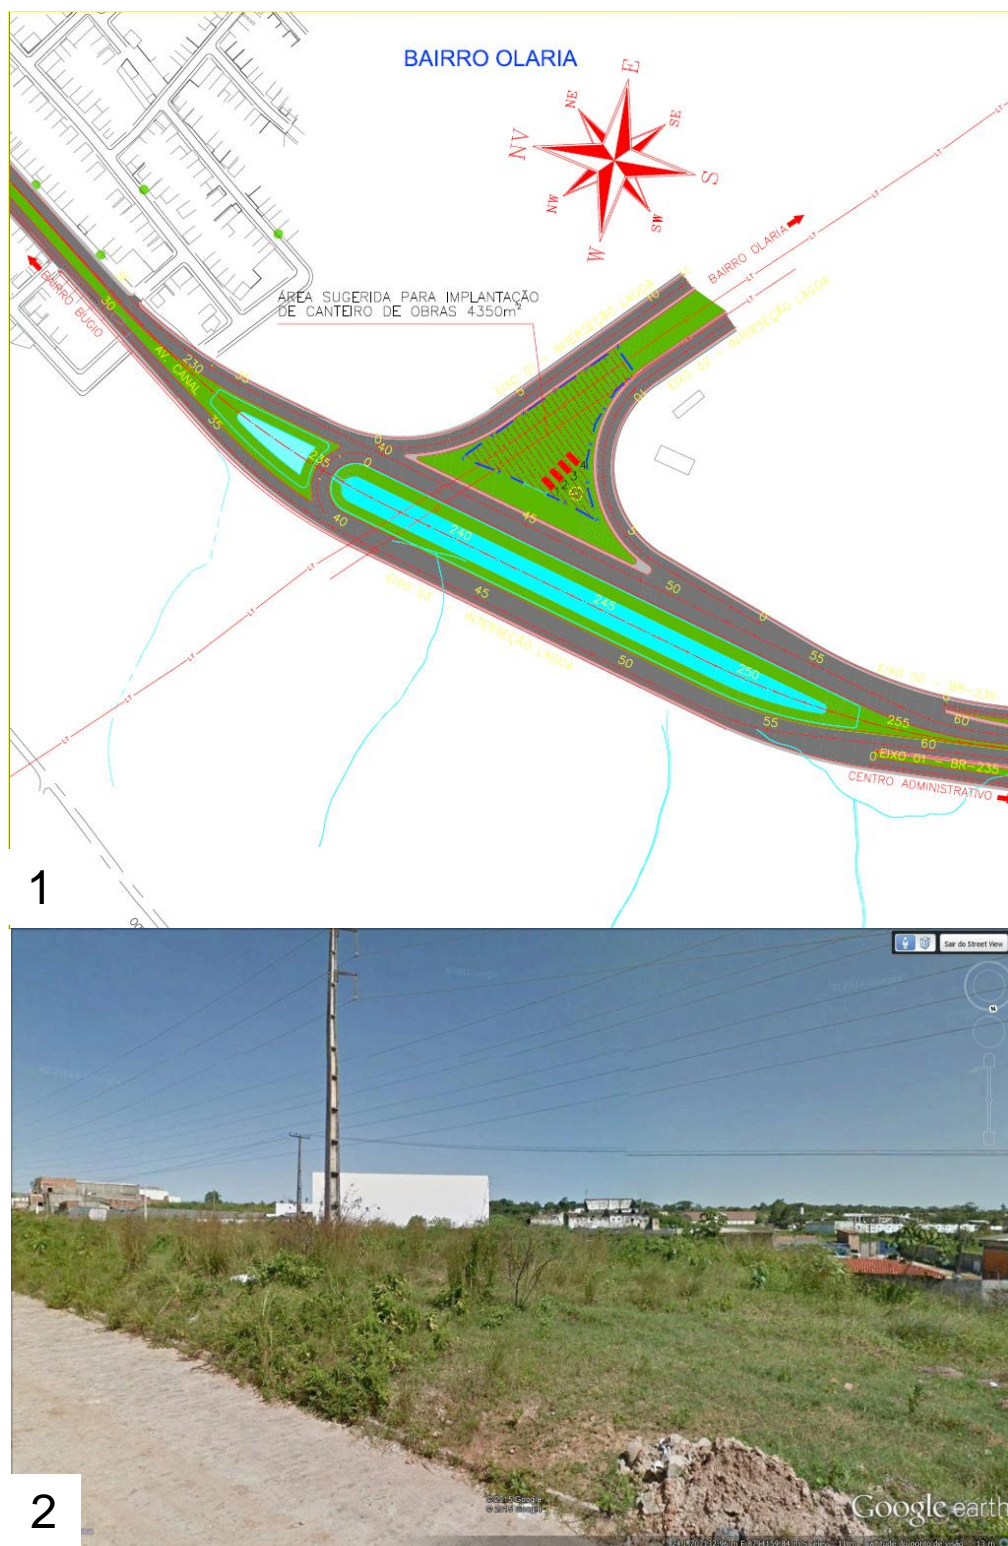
Sugestão para localização do canteiro de obras com área proposta de 4350 m².
